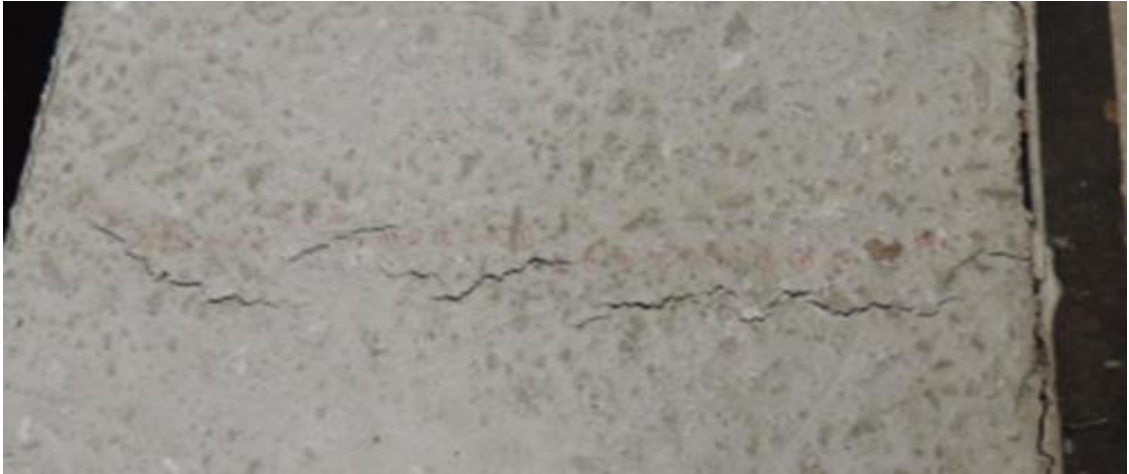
Fisuras por contracción plástica en losa.
